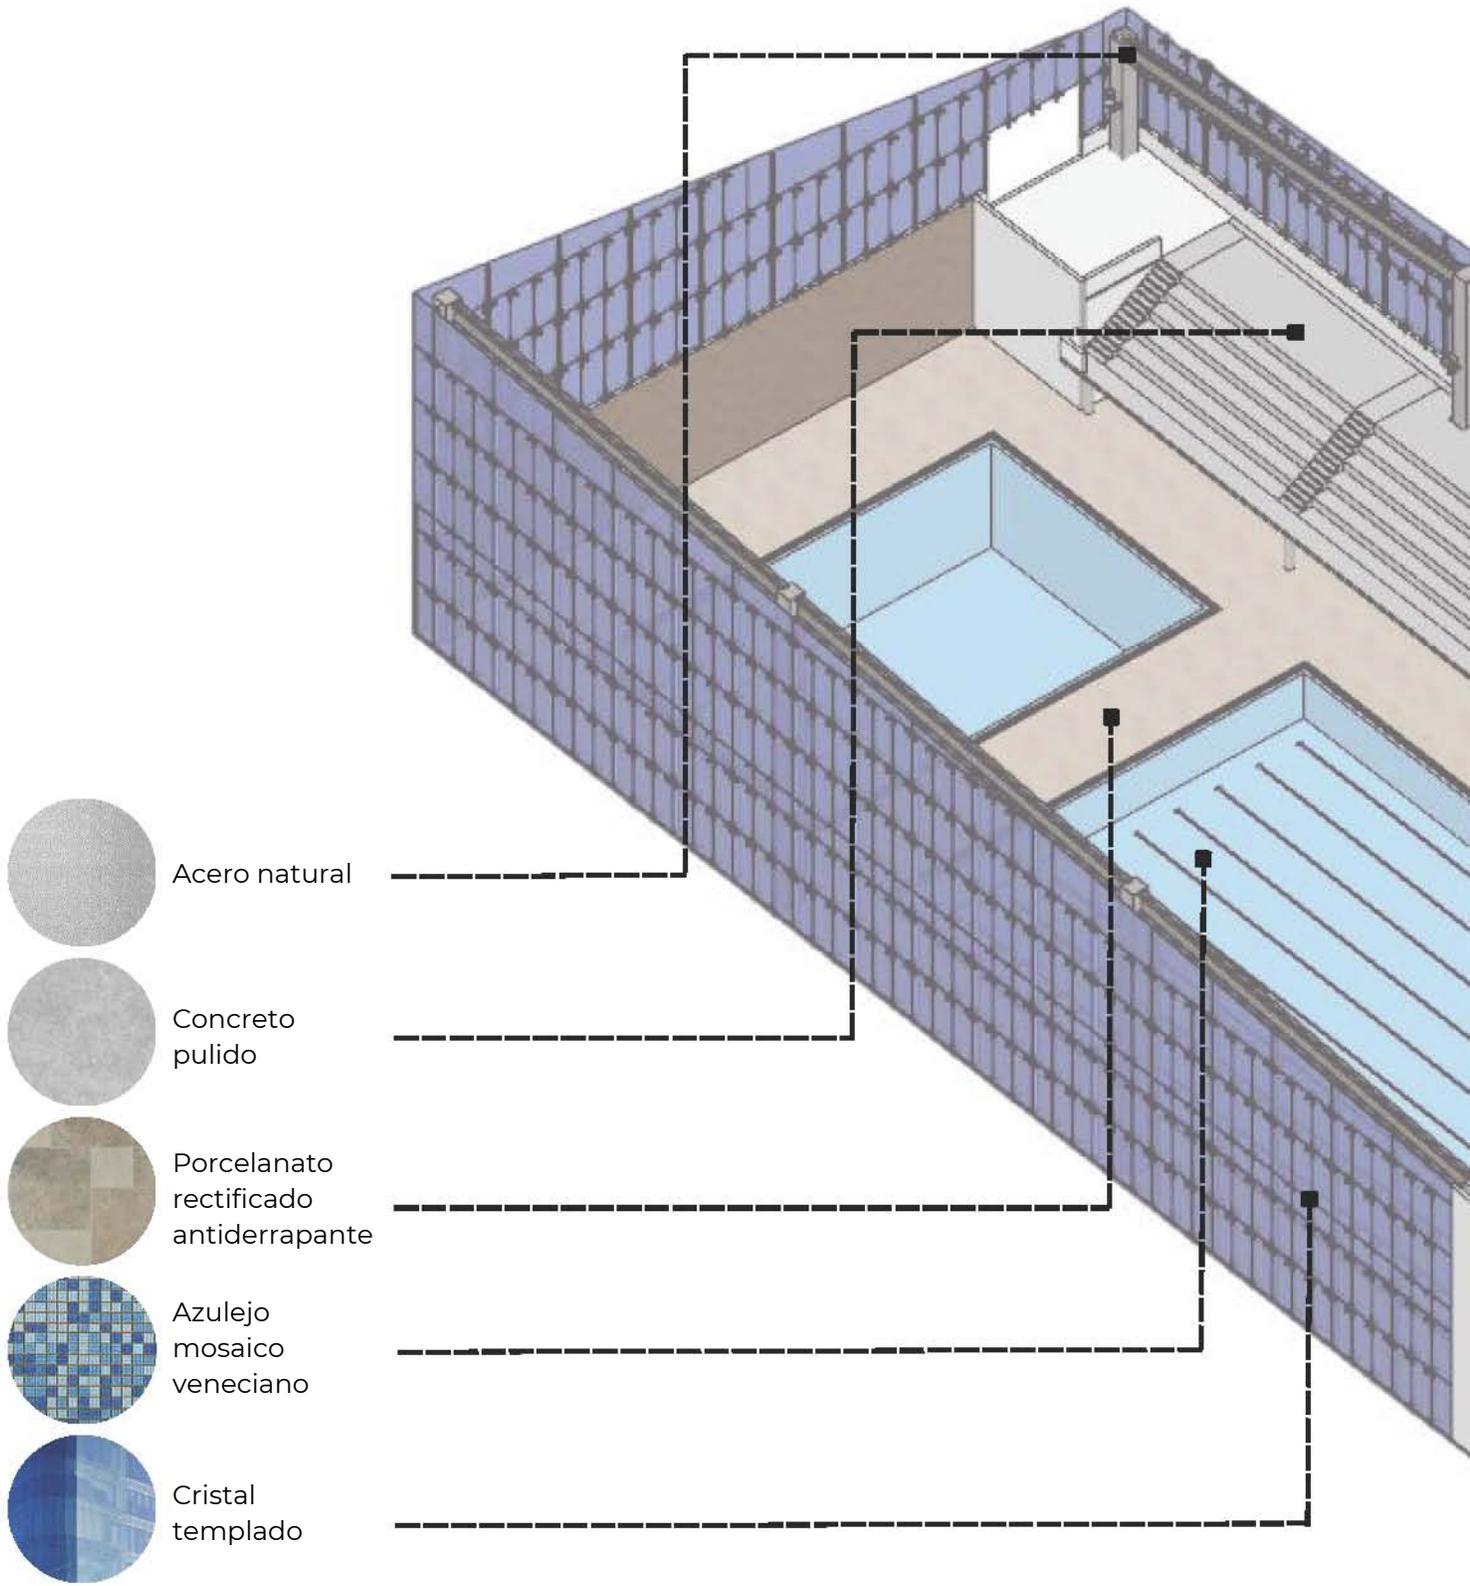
Vista en planta del conjunto CNAR, acabados exteriores.
